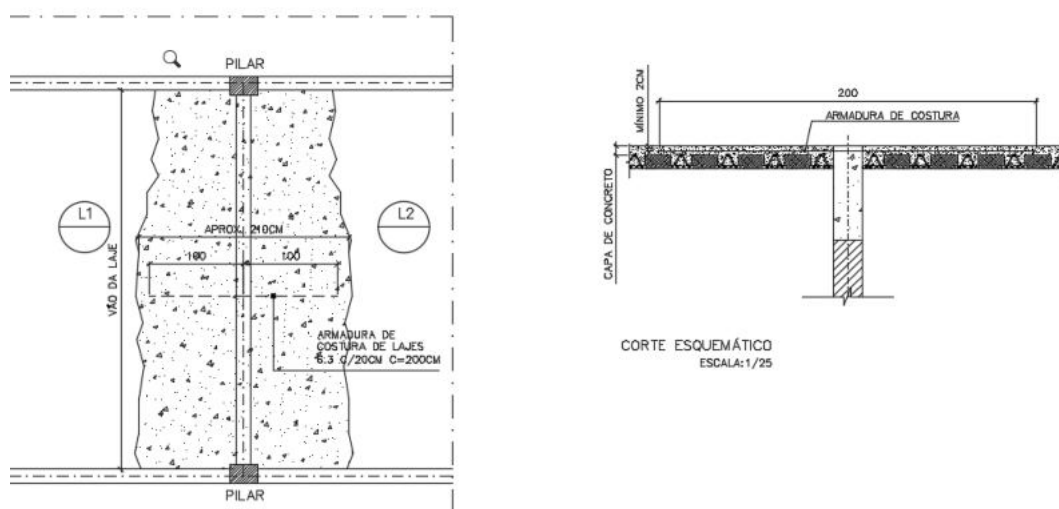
Detalhe Típico - Armadura Negativa (a serem instalados na capa da laje pré moldada ao longo dos apoios (vigas) nos encontros entre as lajes conforme indicado em projeto
